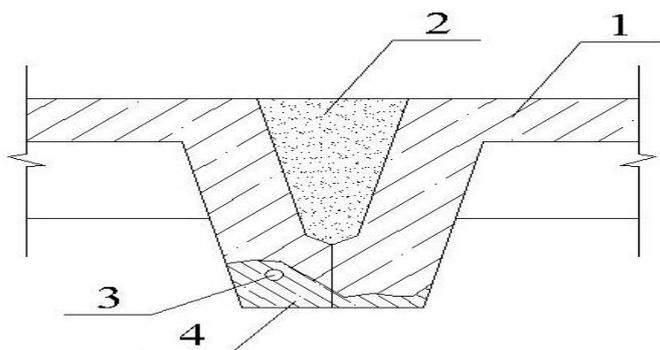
Восстановление сколов ребристых плит перекрытия
